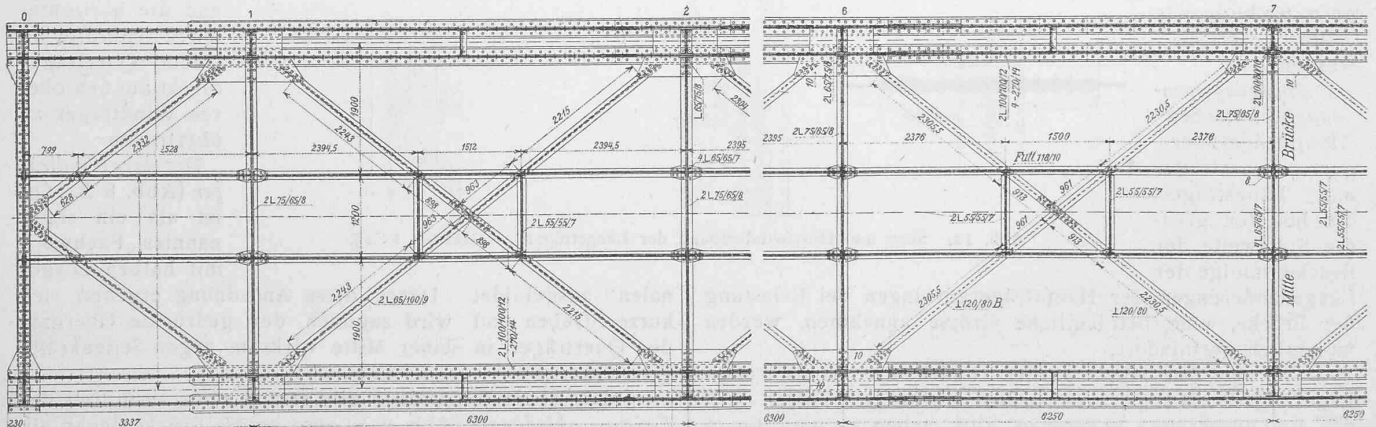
Unterer Windträger und Revisionssteg. Ansicht von oben. — Masstab 1 : 100.
